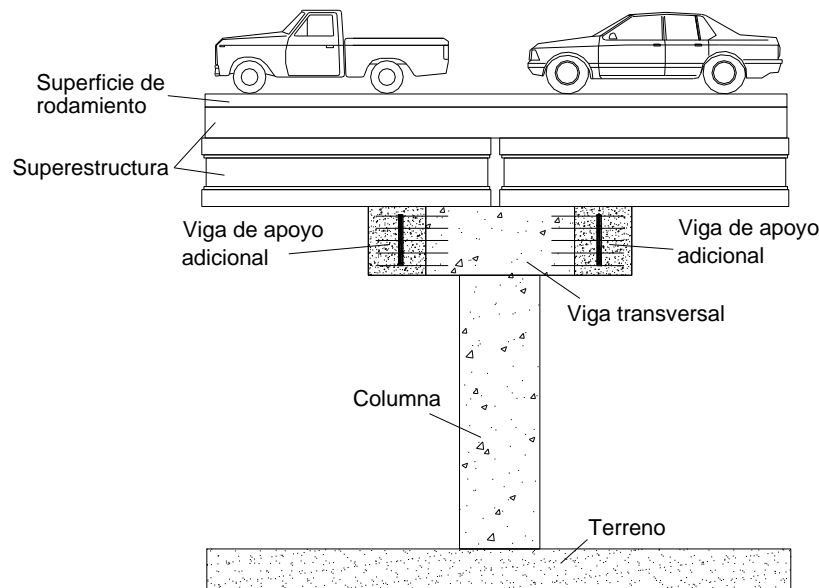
Vigas "bolsters" utilizadas como medida de refuerzo para extender la longitud de asiento del cabezal e incrementar la capacidad de la viga-cabezal [readaptada de (22)].
